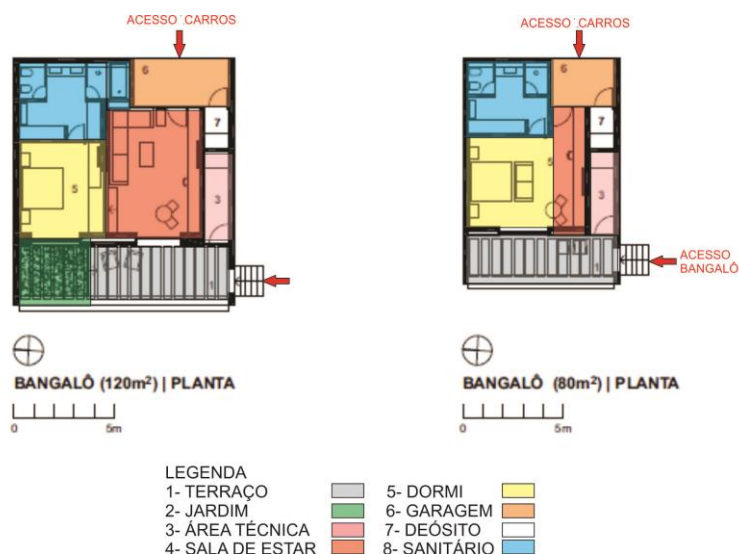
Bangalô - Fasano Las Piedras Hotel
